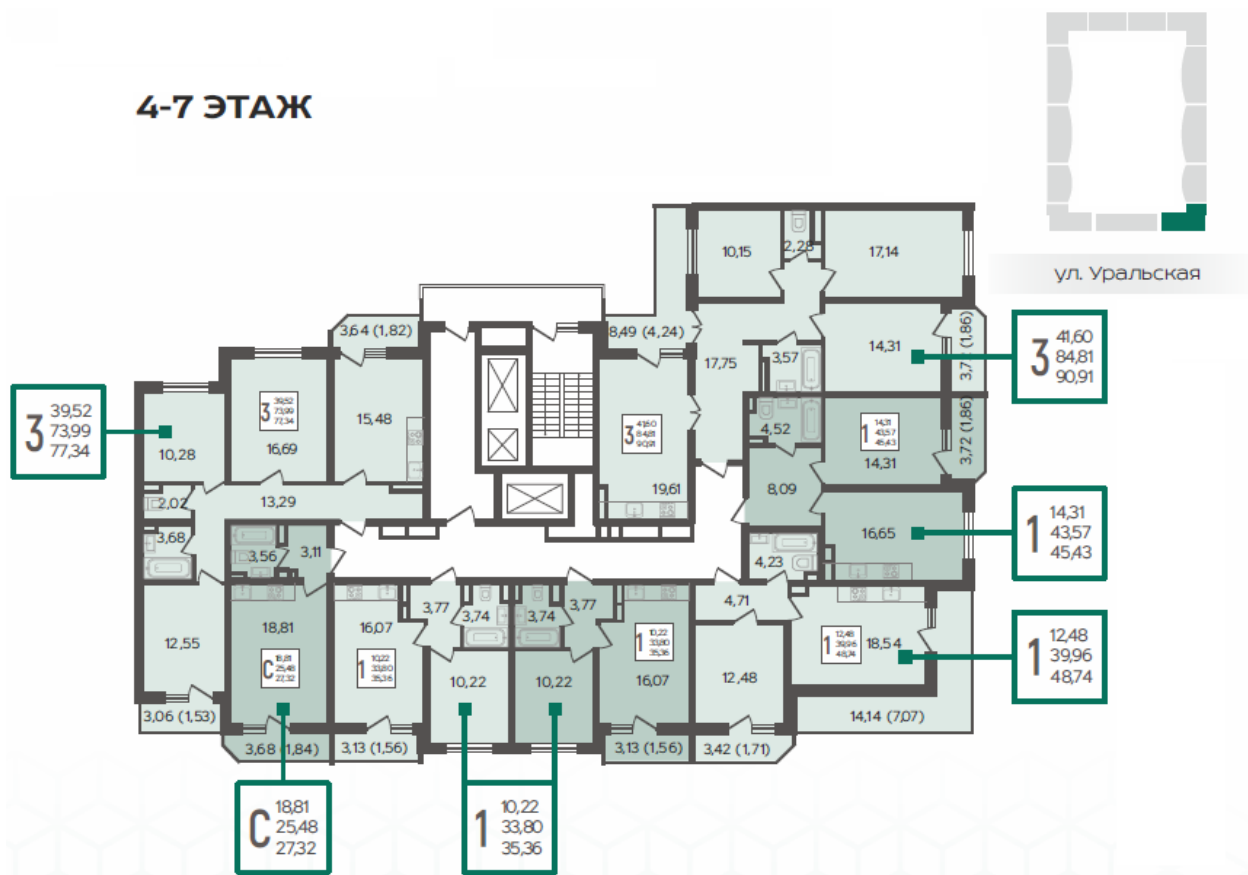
Типовой план 4-7 этажа БС-12 ЖК URAL
